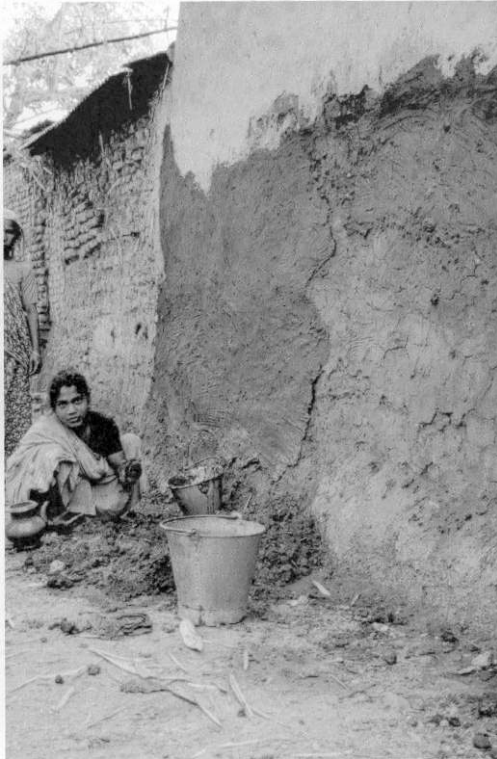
L'épouse recouvre d'un enduit le mur extérieur de sa maison
